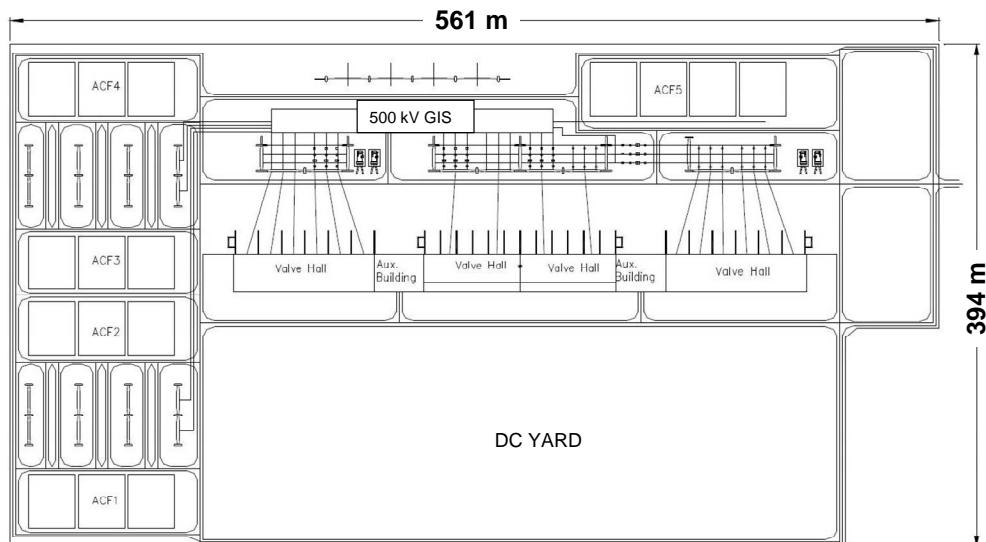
Layout einer Konverterstation mit gasisolierter Anlage im AC-Bereich [TB 417]
